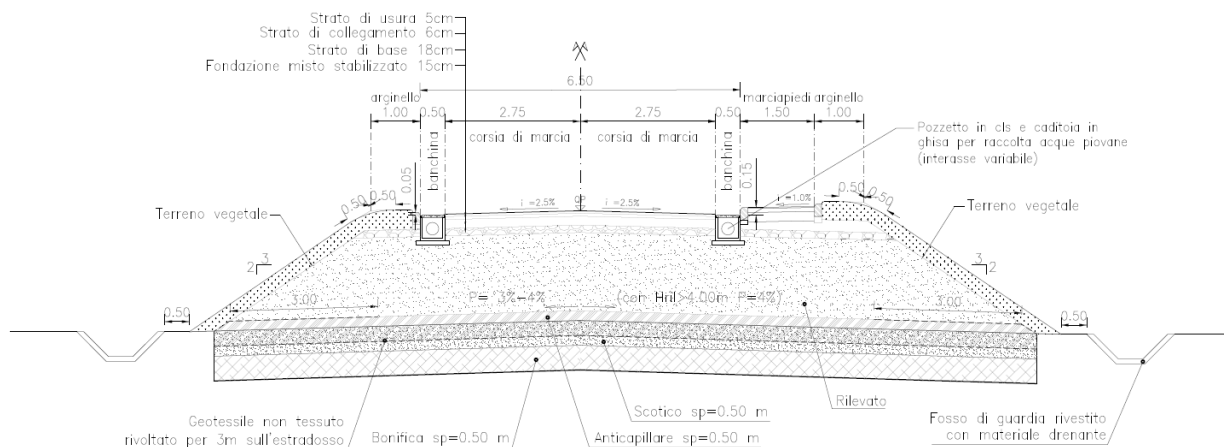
VIABILITÀ NV01 - SEZIONE TIPO IN RILEVATO
